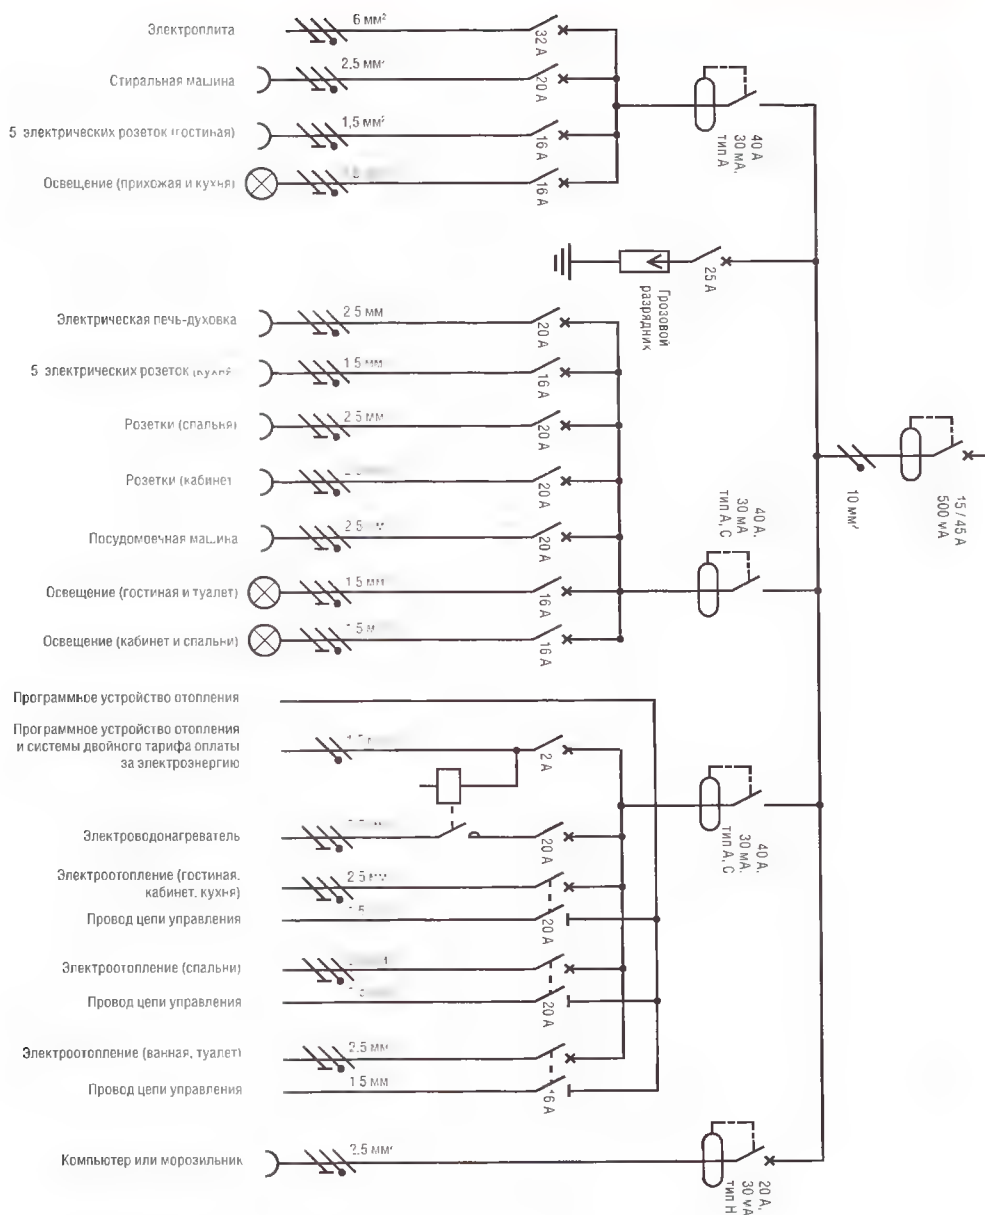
Пример схемы электропроводки для квартиры площадью 35 — 100 м²
